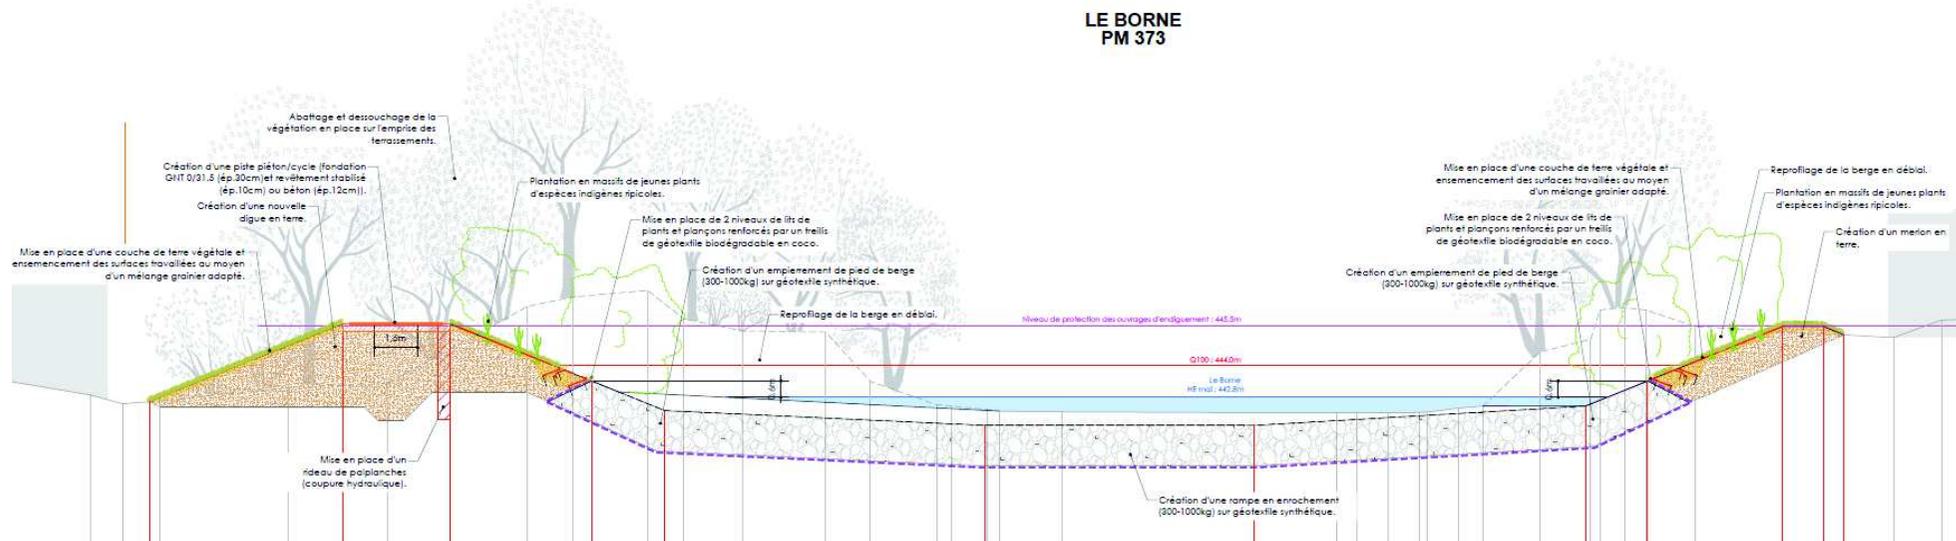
Profil type au droit rampe de stabilisation du lit du Borne / PM373
